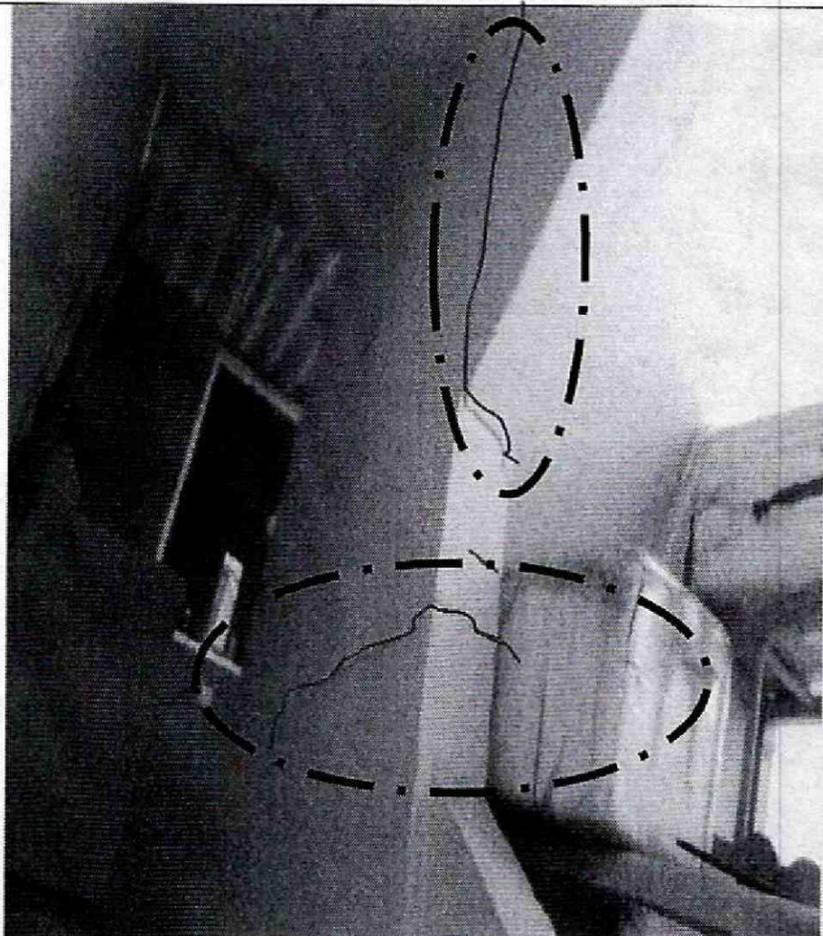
Fisuras identificadas en muros de cerramiento y divisorios en la viviendas de la Carrera 98 B No 136 - 64
